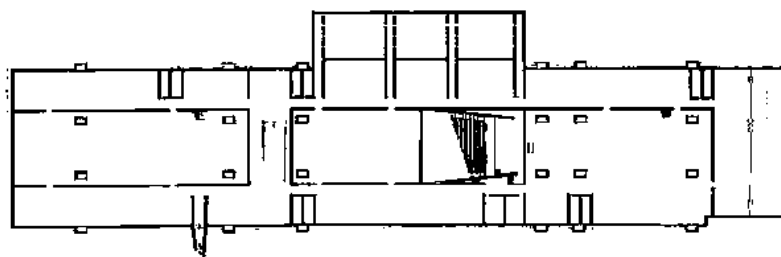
Edifício Castelo Branco – planta do subsolo antes da intervenção
